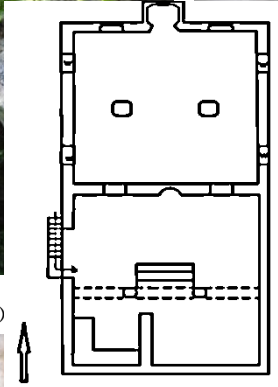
مسقط أفقي لمسجد ميوماجي -تنزانيا
